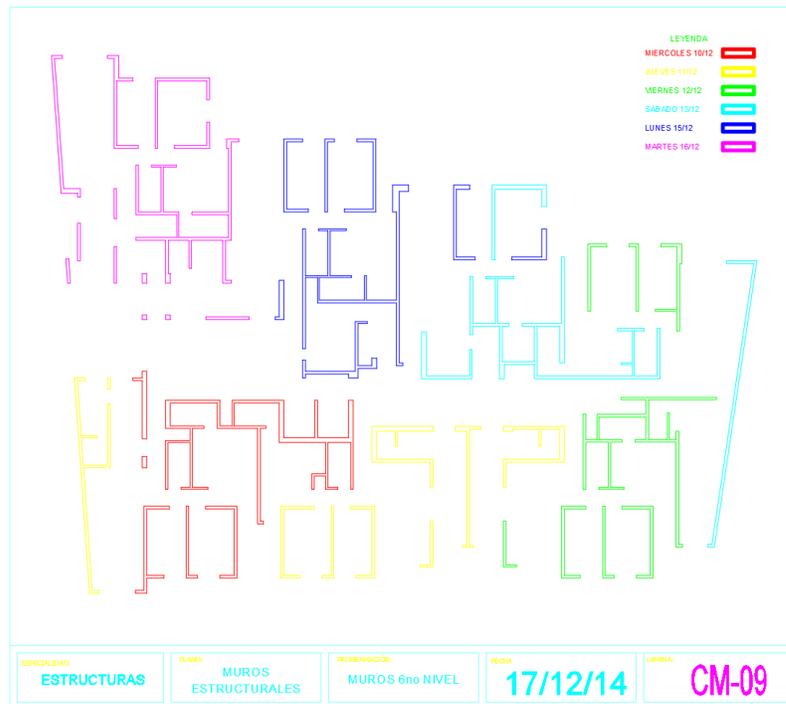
Sectorización de Muros Nivel 9. Fuente: Elaboración Propia
